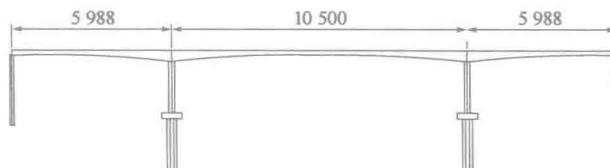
神龙高架四桥桥跨布置(尺寸单位:cm)
